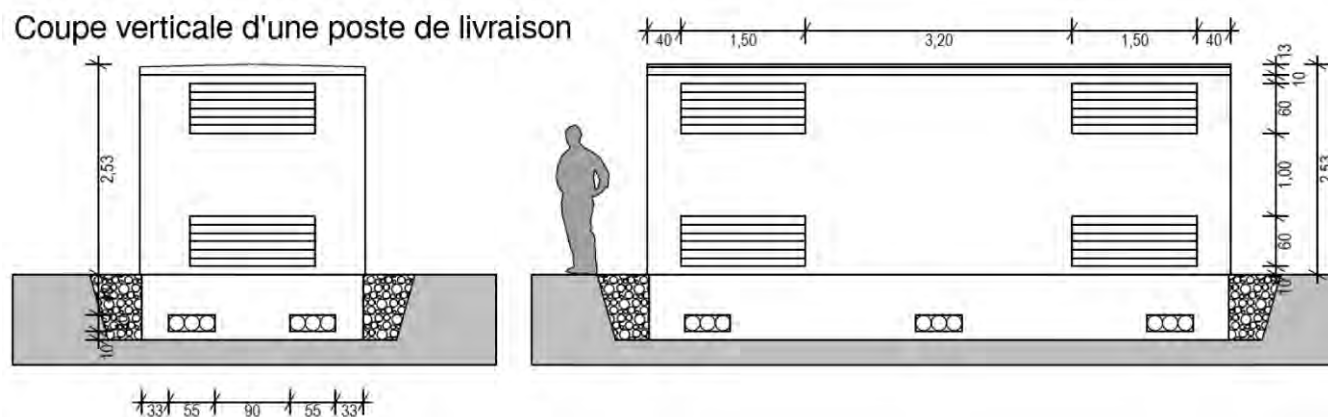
Exemple de coupe verticale d'un poste de livraison
